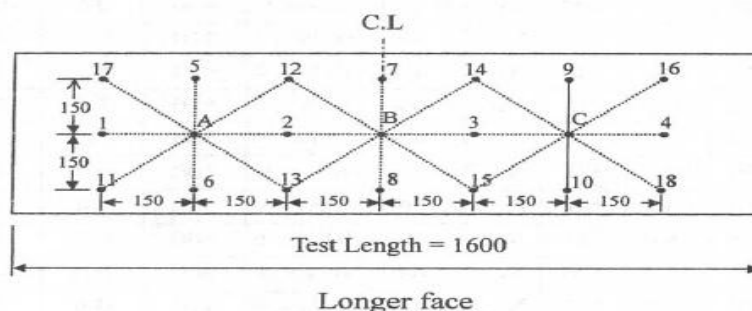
Colocação de pontos alvo de cobre na face de uma viga [27]
